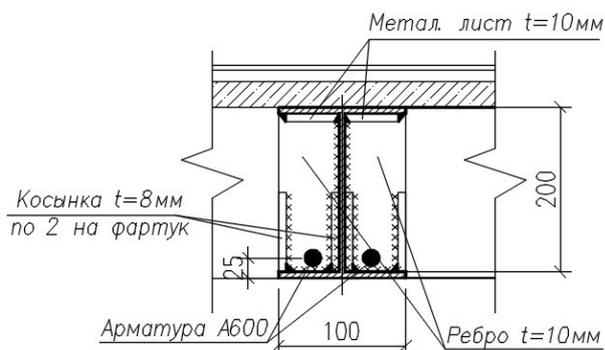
Усиленное сечение балки монолитной плиты перекрытия по профнастилу.
